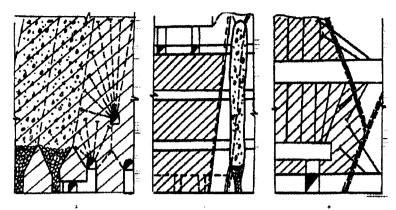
Система подэтажного обрушения с канатно-металлическим перекрытием: 1 — откаточный орт; 2 — откаточный штрек; 3 — наклонный съезд; 4 — рудоспуск монтажного слоя; 5 — руда; 6 — перекрытие
